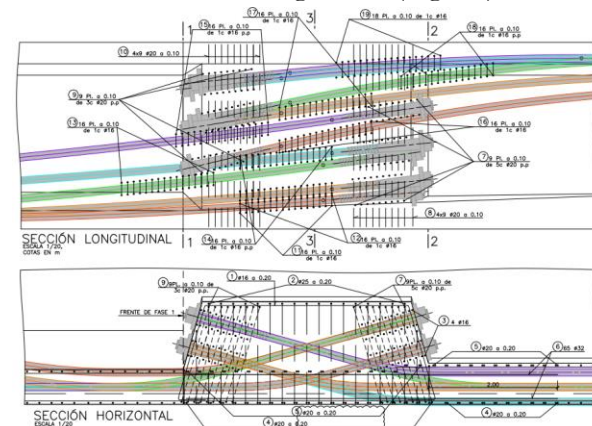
Alzado y planta del frente de fase del Viaducto de Mesón de Calvos.
